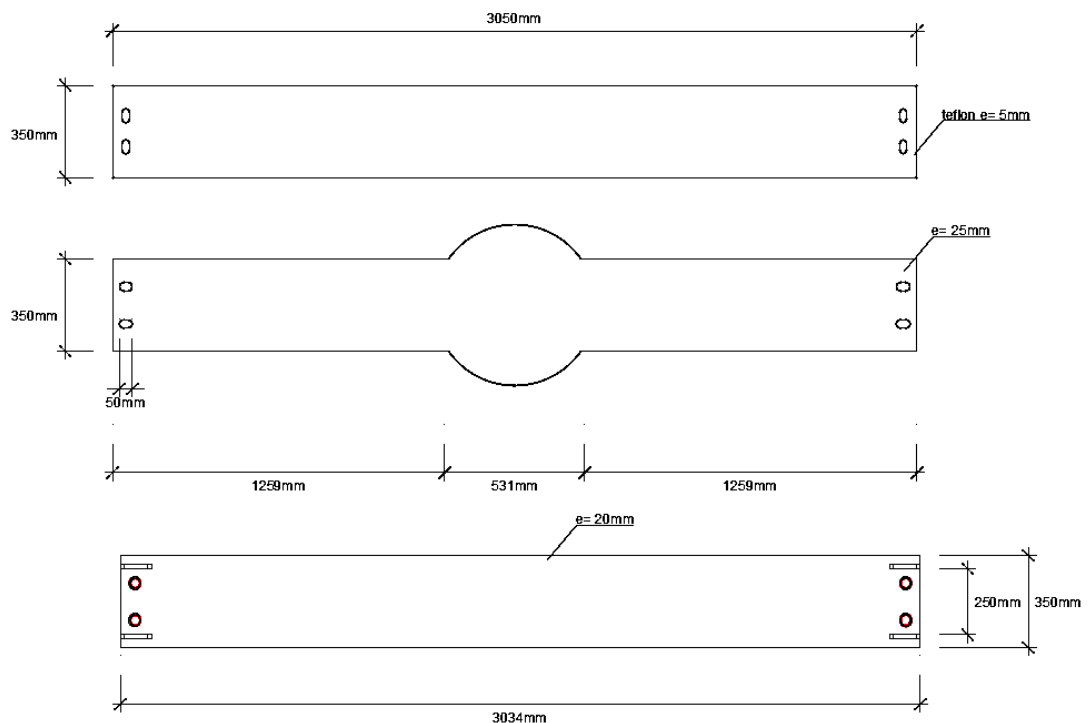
Elementos em chapa da ligação entre pilares e escadas
